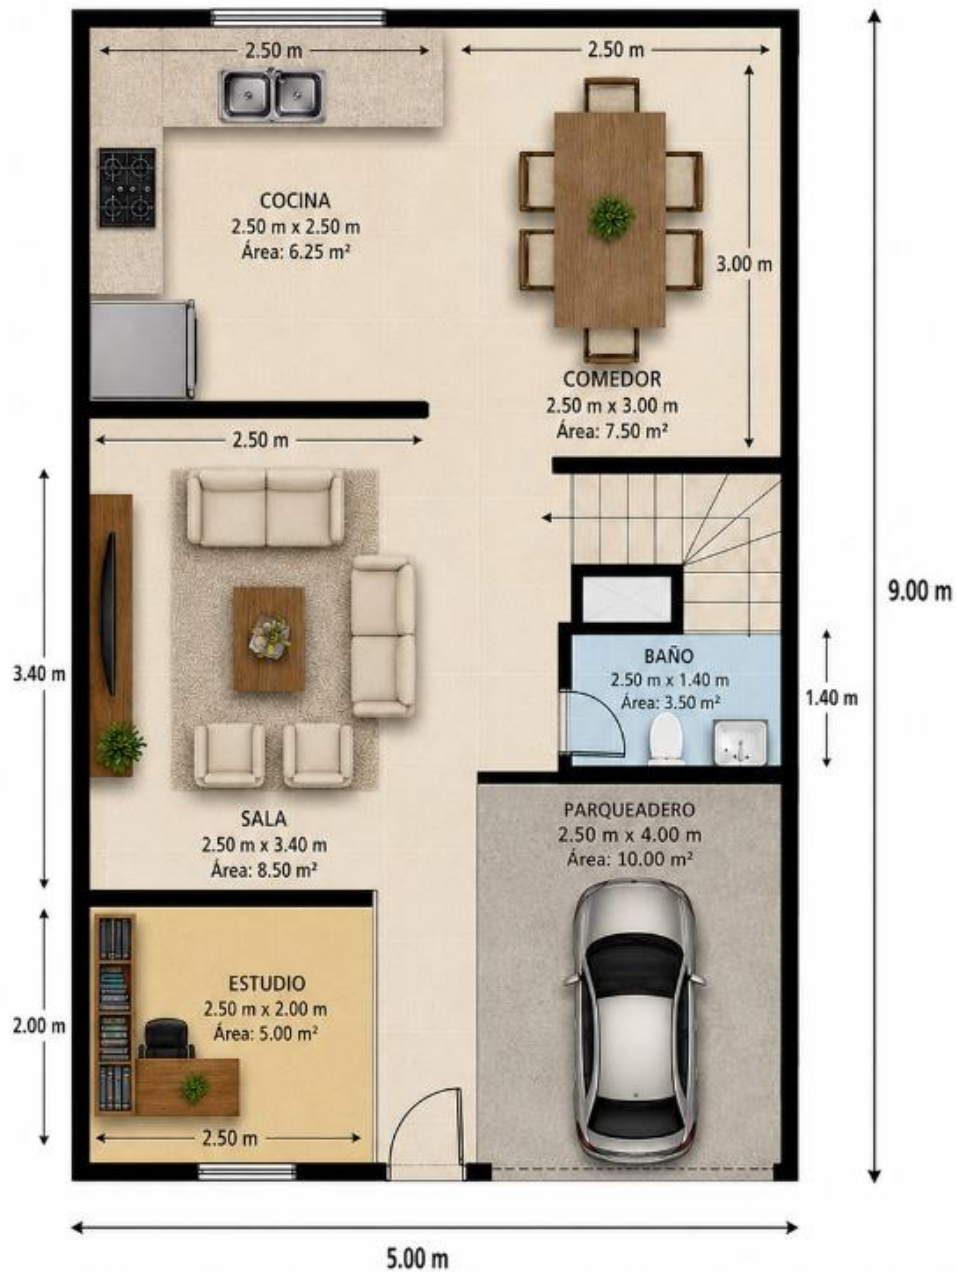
Planta arquitectónica del primer piso. Fuente: Propia.
